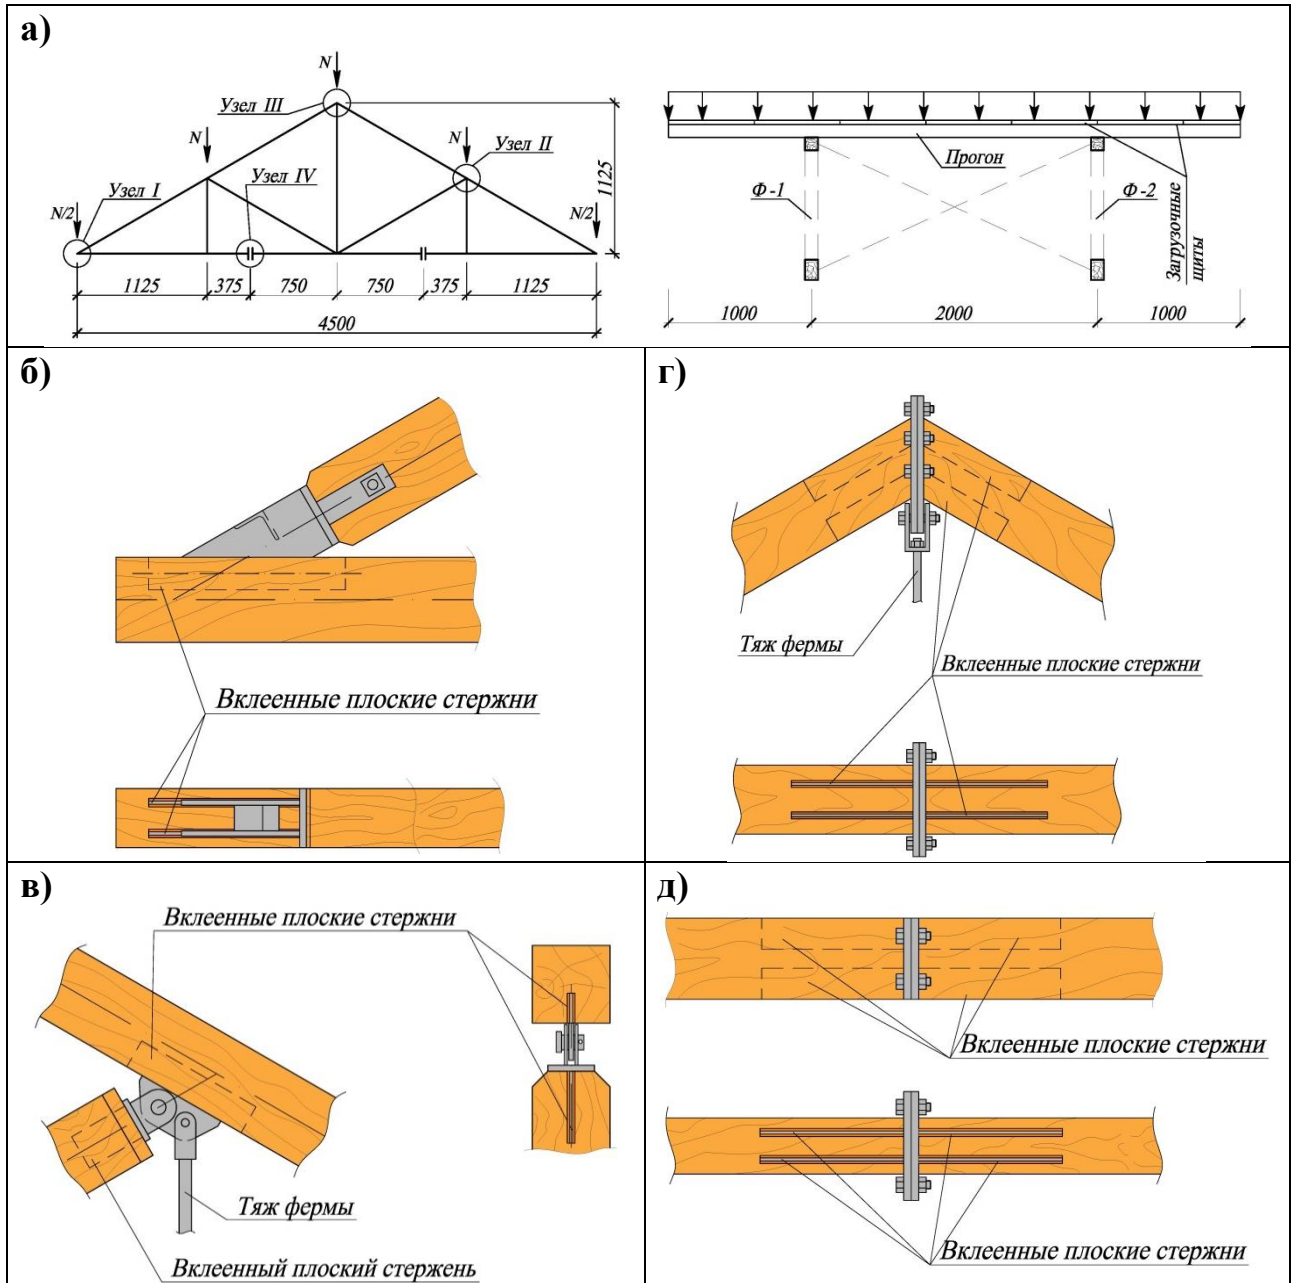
Схемы опытной конструкции фермы: а – геометрическая схема опытной конструкции и её загрузки; б – узел 1; в – узел 2; г – узел 3; д – узел 4
